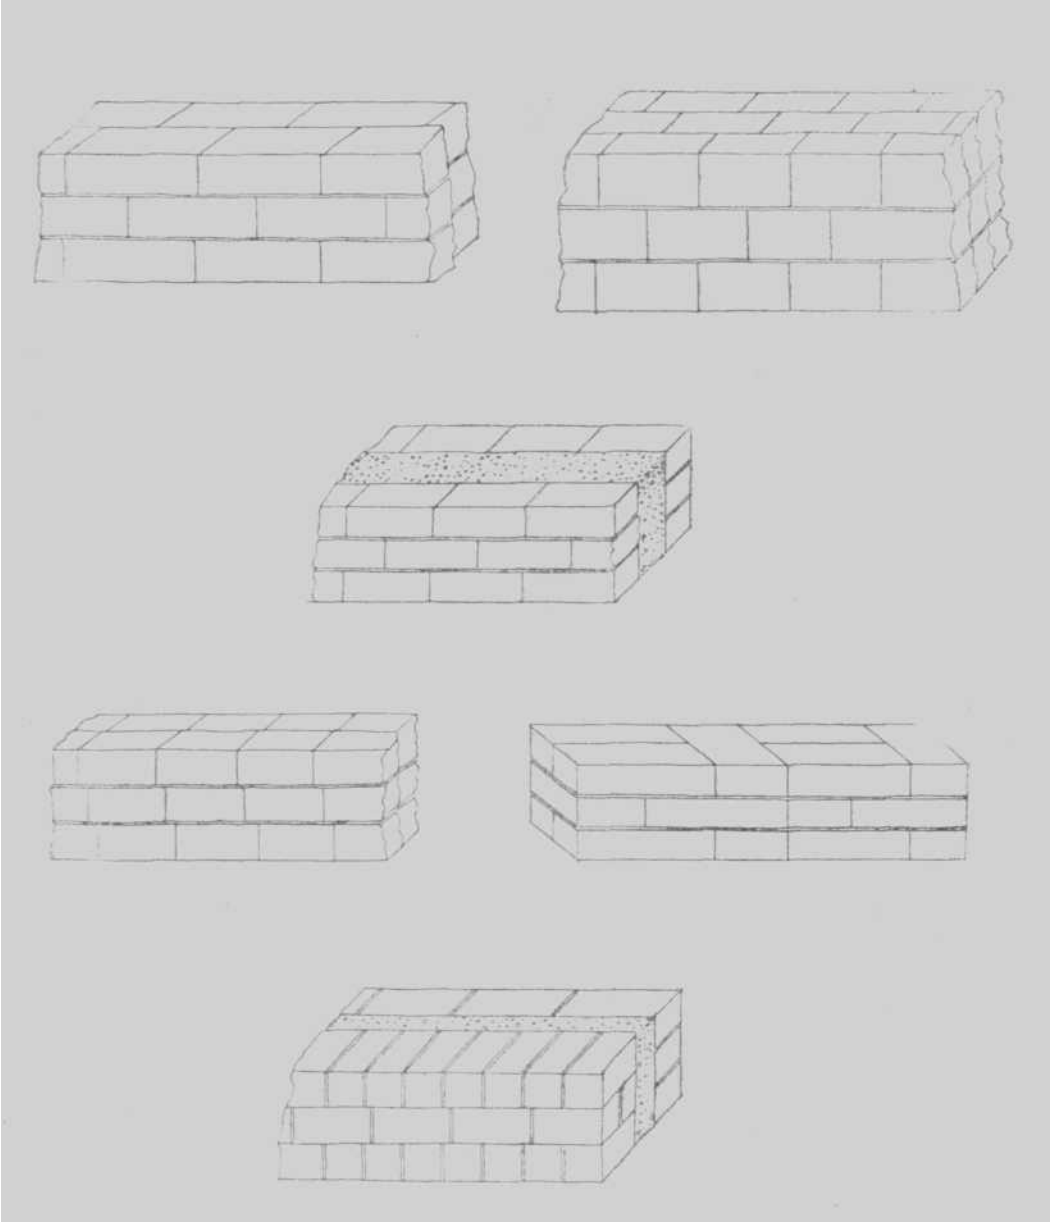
ª Disposición del aparejo de los muros edificados en adobe
